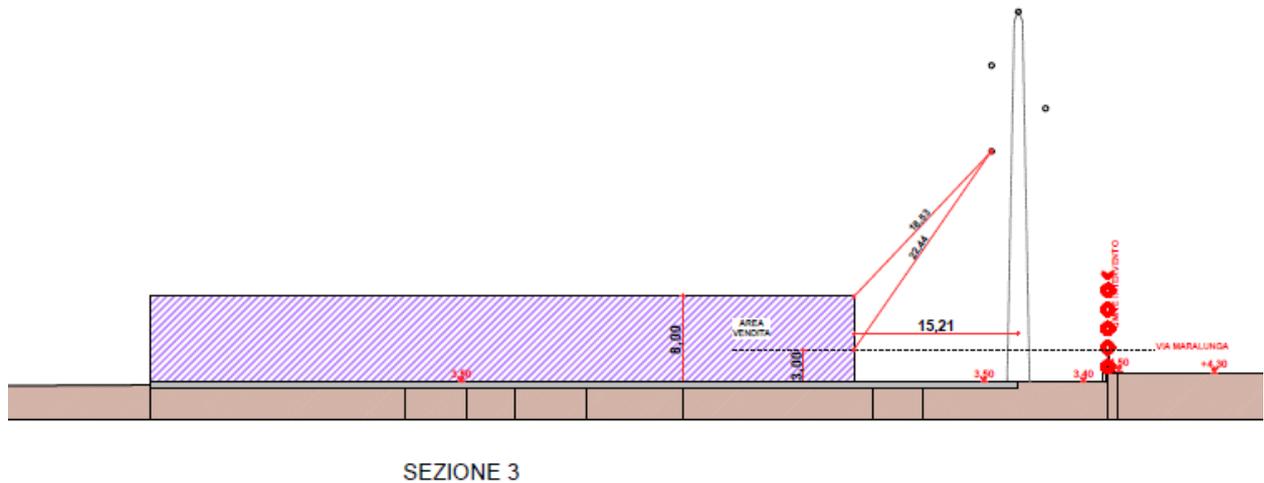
Sezione nel punto di minore distanza in pianta tra il nuovo edificio del Lotto 1 e l'elettrodotto
